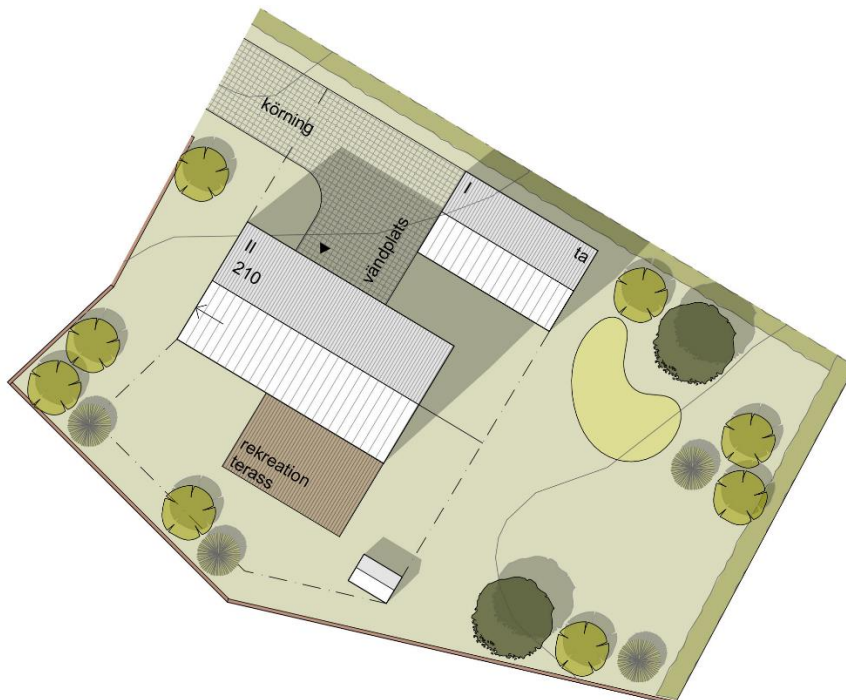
Idébild om placeringen av byggnader och konstruktioner
